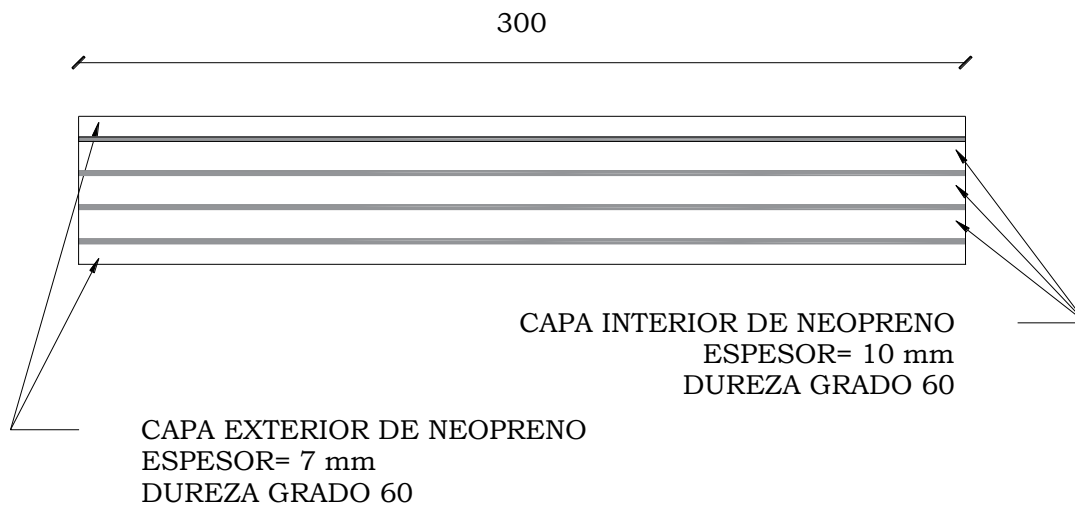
Vista transversal de apoyo de neopreno. Elaborado por: Autores.
